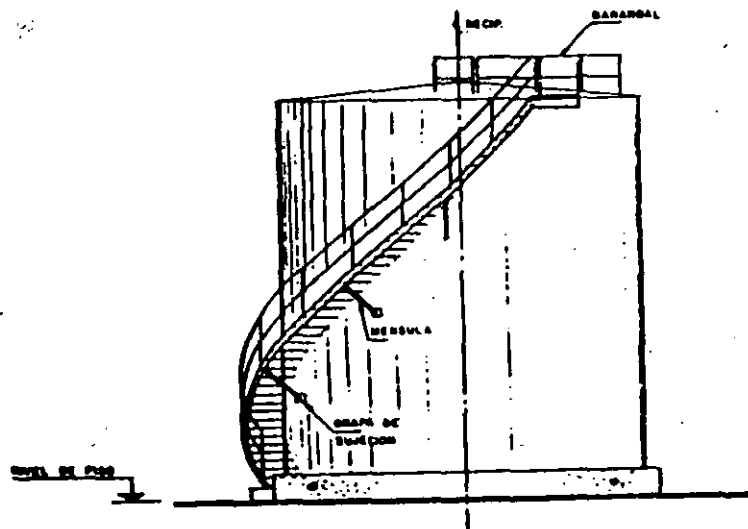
ESCALERA HELICOIDAL Y BARRANDES PARA RECIPIENTE ATMOSFERICO
